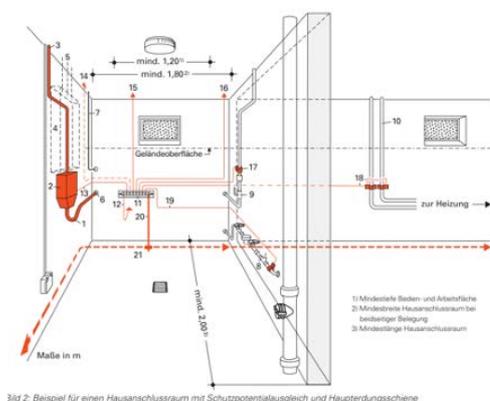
Beispiel für einen Hausanschlussraum mit Schutzpotentialausgleich und Haupterdungsschiene
